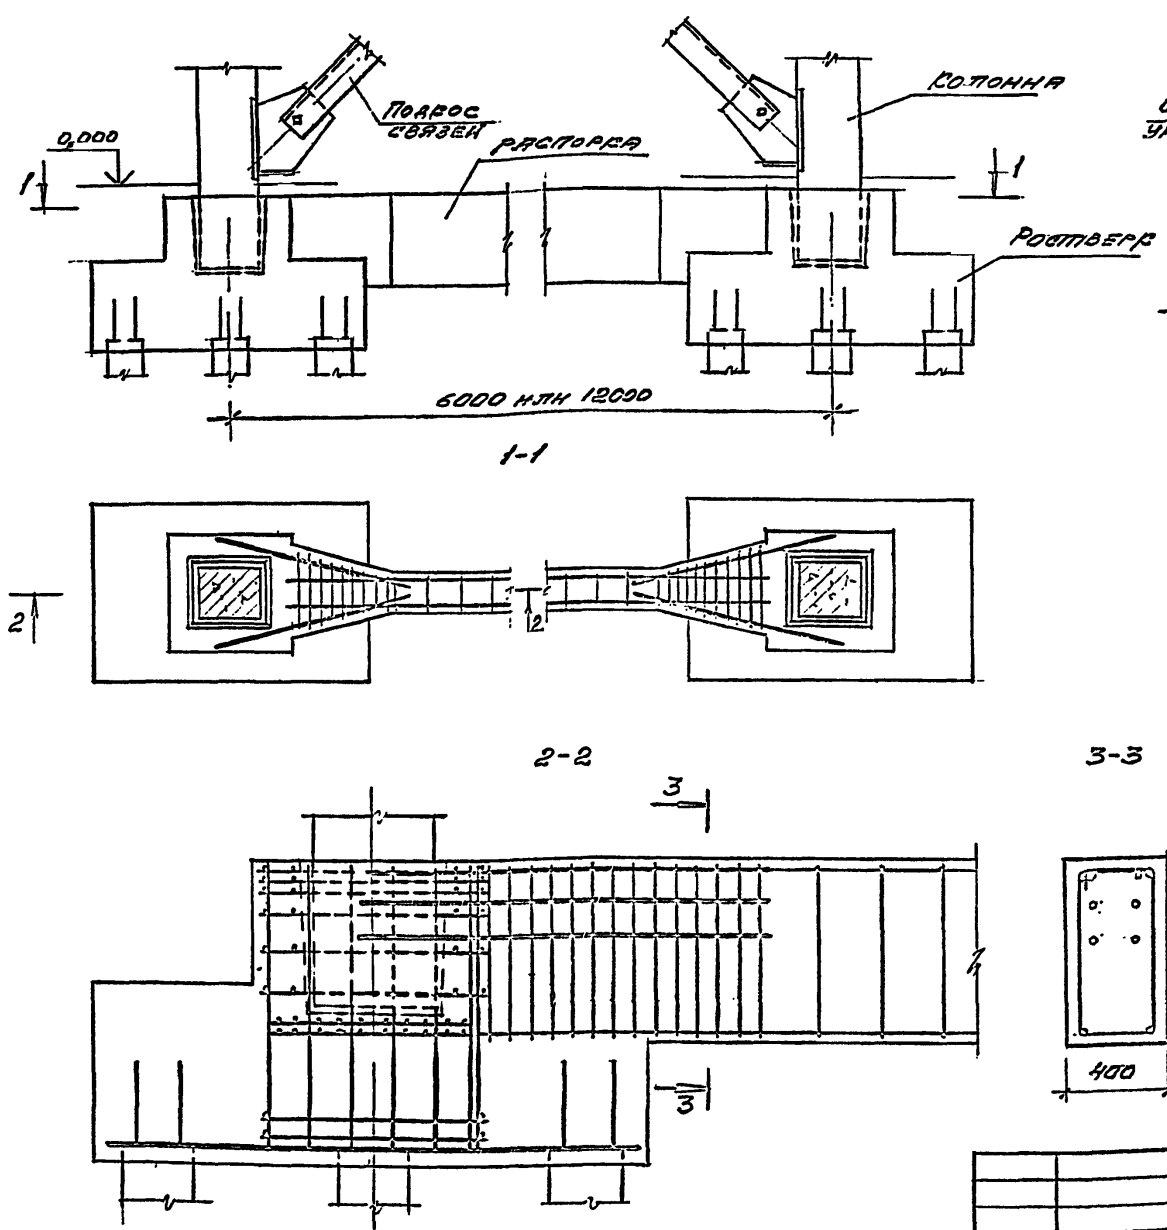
Соединение фундаментов связевого блока железобетонной распоркой
